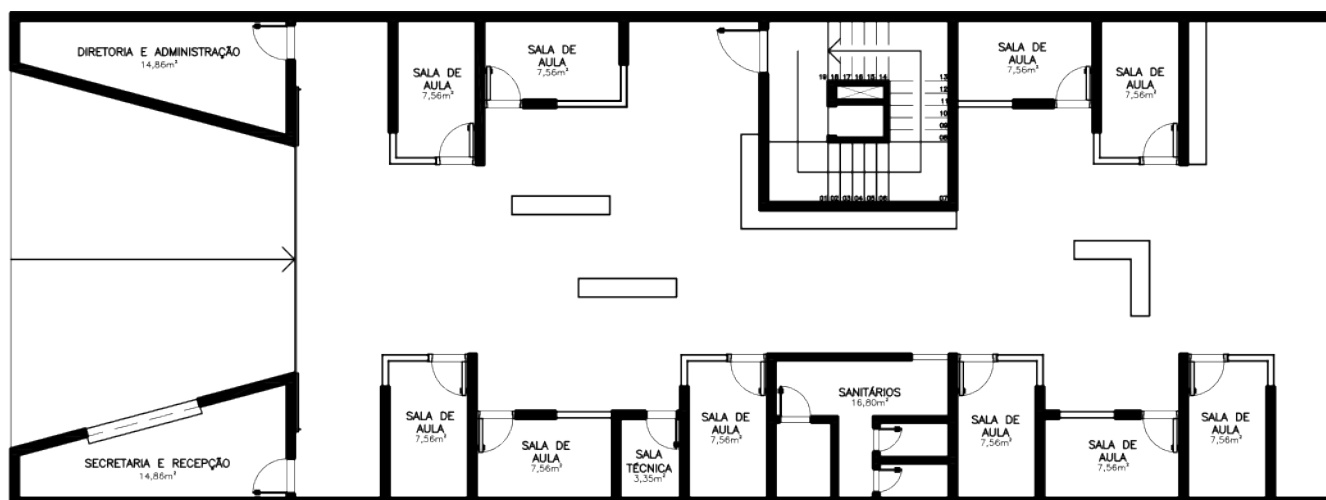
BLOCO SALAS DE AULA - PLANTA 0 - ESC.: 1:200
